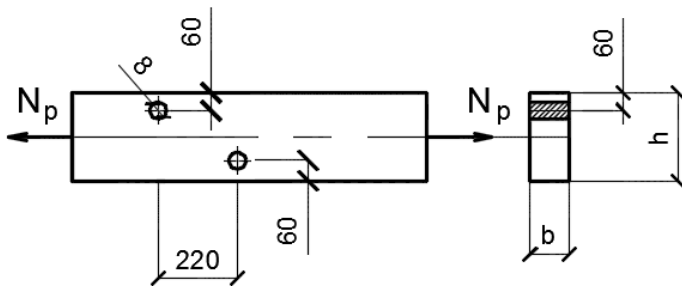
Растянутый пояс фермы и расчетное сечение
